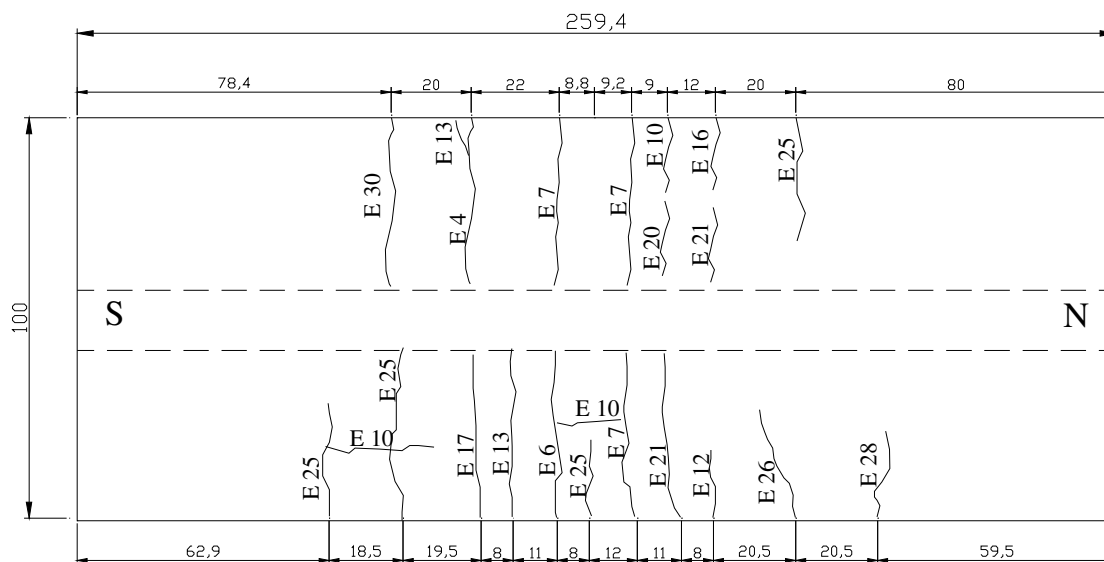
Fissuras do modelo 4A (face superior da laje) – medidas em cm.
